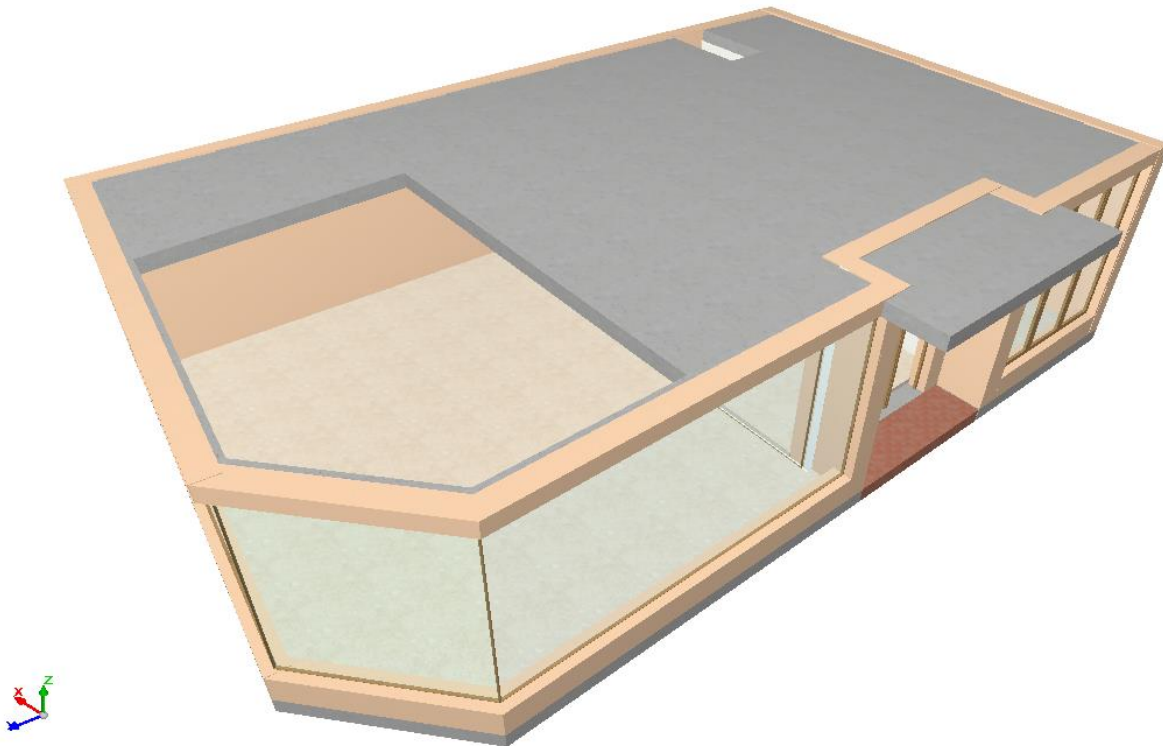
Vista del hueco en el forjado sobre la sala de exposiciones situada en la planta baja
